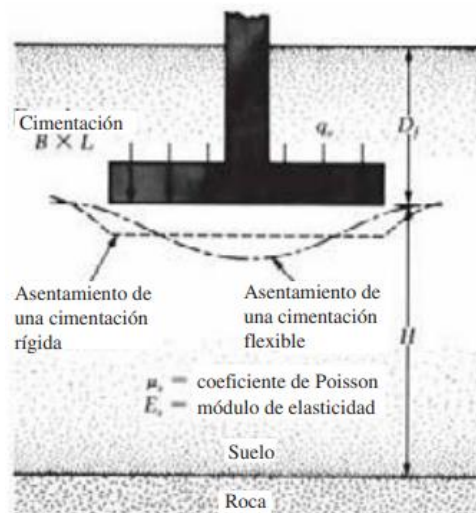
Asentamiento elástico de cimentación flexible y rígida.
